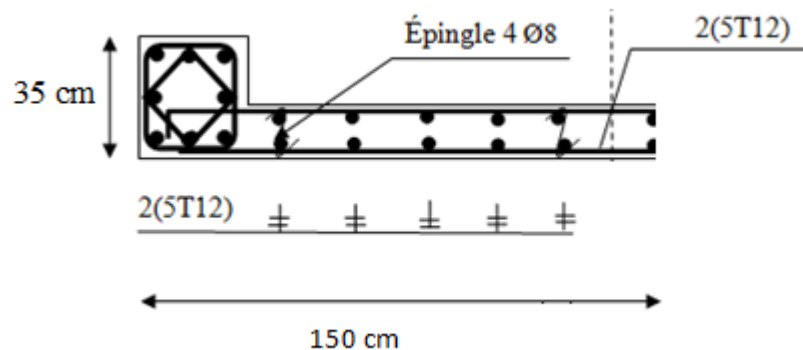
Schéma de ferrailage du mur voile (Type 3)
